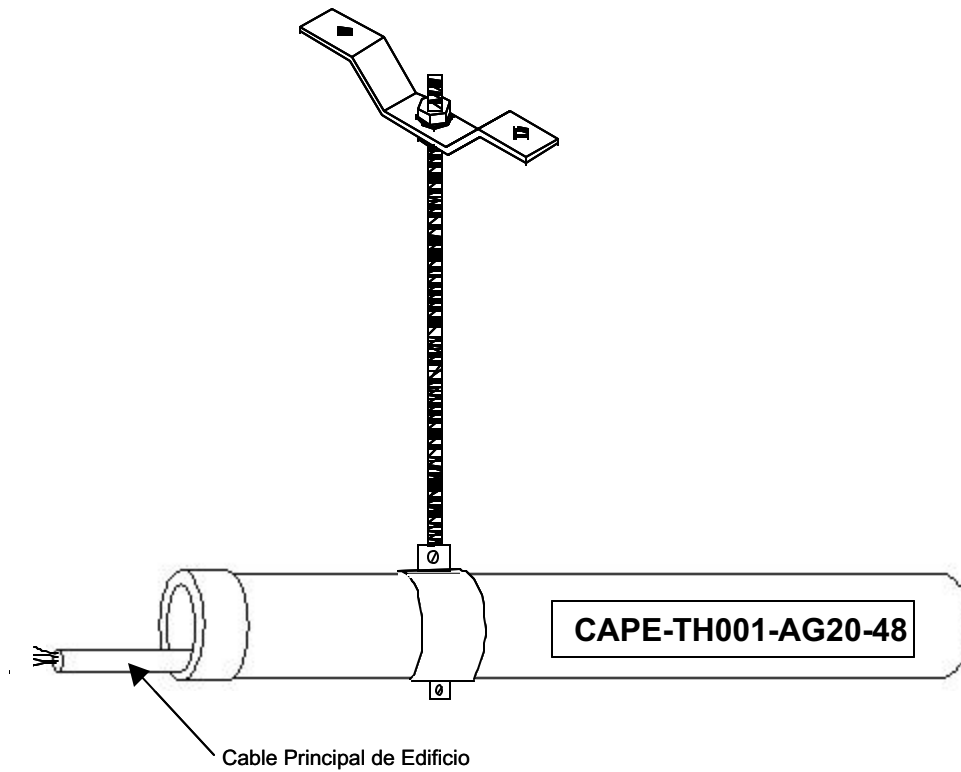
Ejemplo de etiquetado de tubería.
